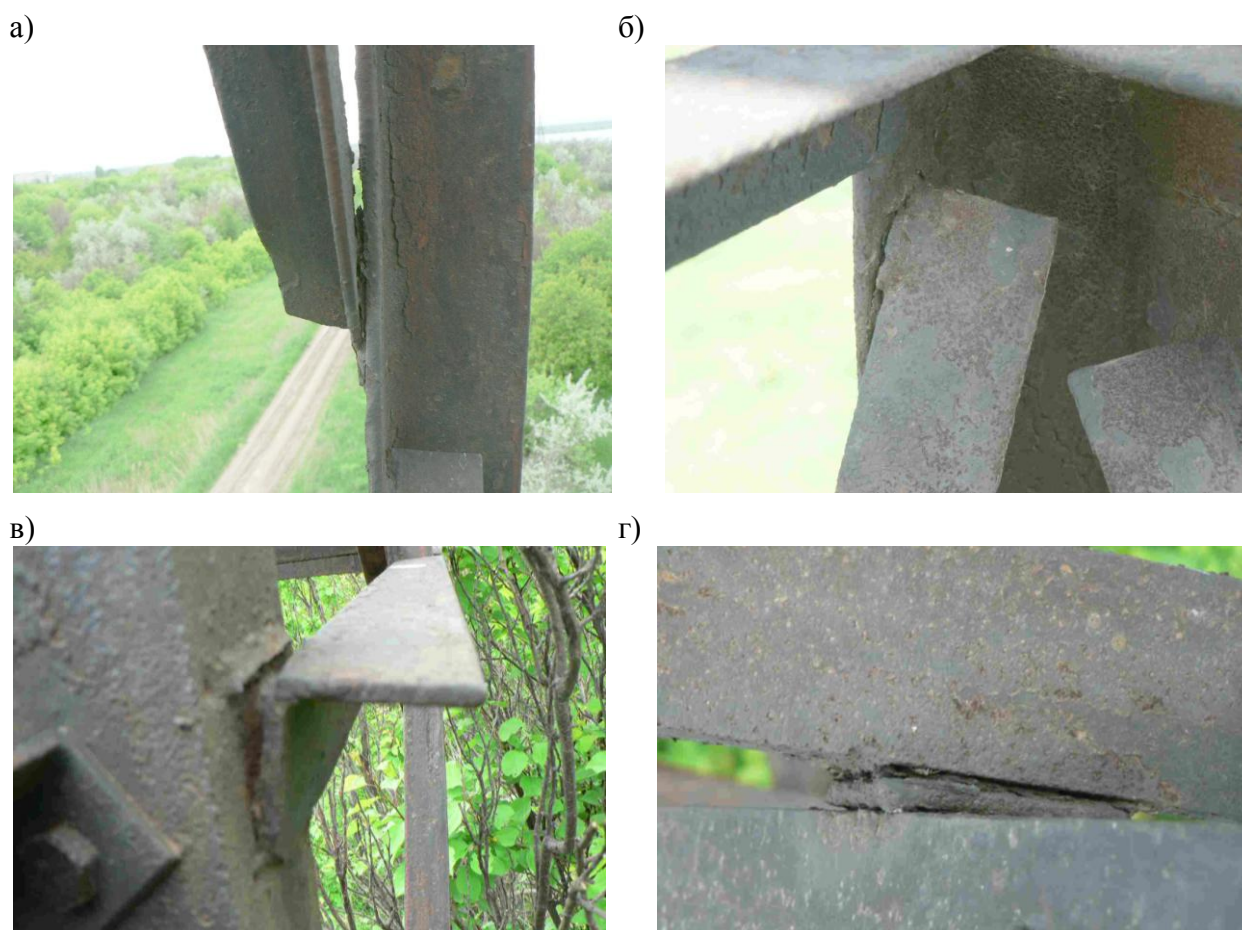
Щелевая коррозия в сварных и одноболтовых соединениях решетки опор: а – в узлах примыкания решетки к поясу без появления трещин в сварных швах; б – то же, с разрушением сварного шва; в – с отрывом элемента распорки от пояса; г – в сварных узлах перекрестной решетки.
